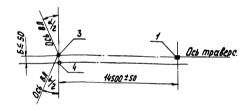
Допуски на разбивку котлованов.
